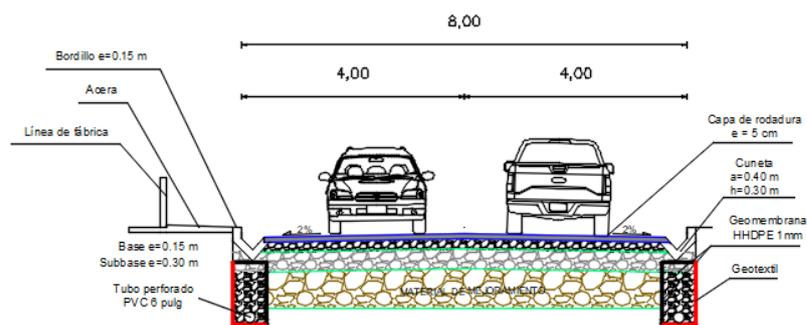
Alternativa 1. Uso de geotextil y alcantarilla
